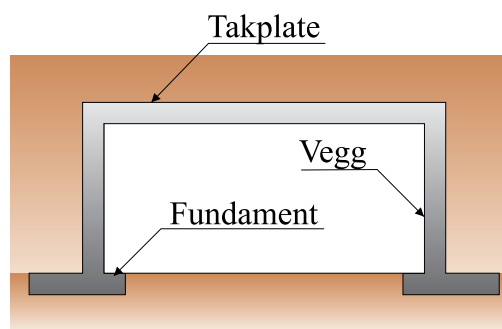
Kulvert, plassprodusert, med sålefundament. Byggverkstype 112
